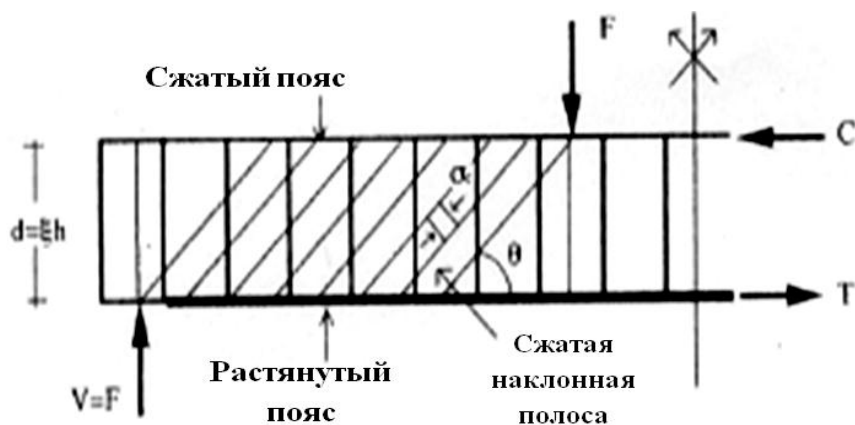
Аналоговая модель фермы для расчета усиленной железобетонной балки
